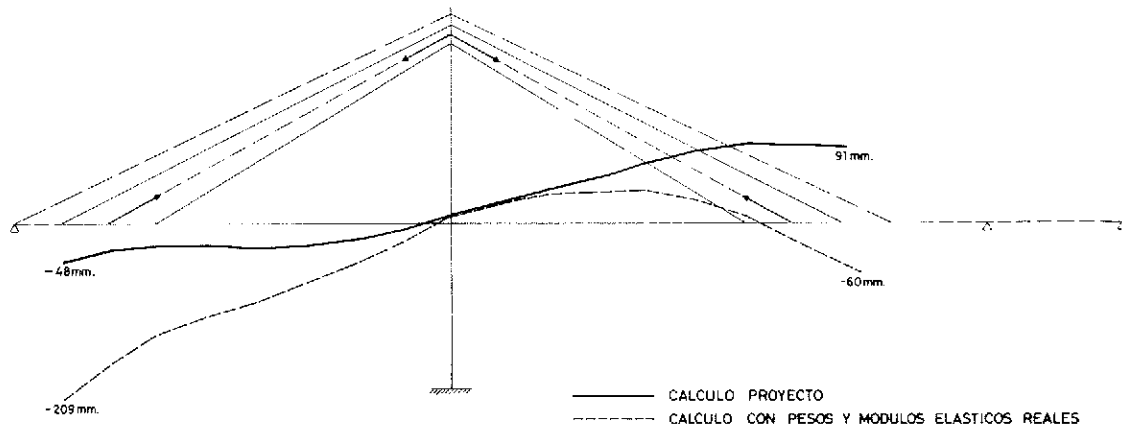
Deformada tablero en fases avanzadas del montaje.
